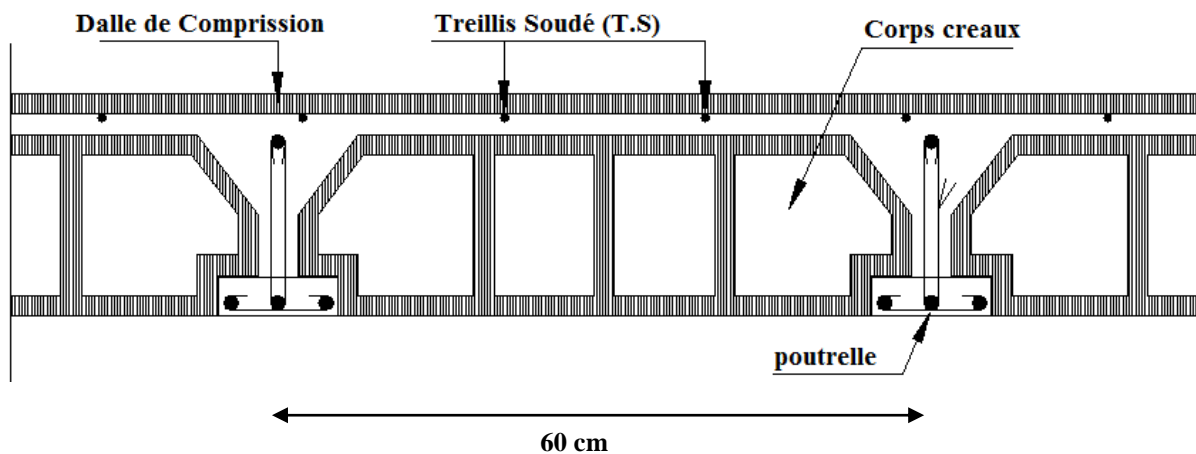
Coupe verticale d'un plancher en corps creux.
